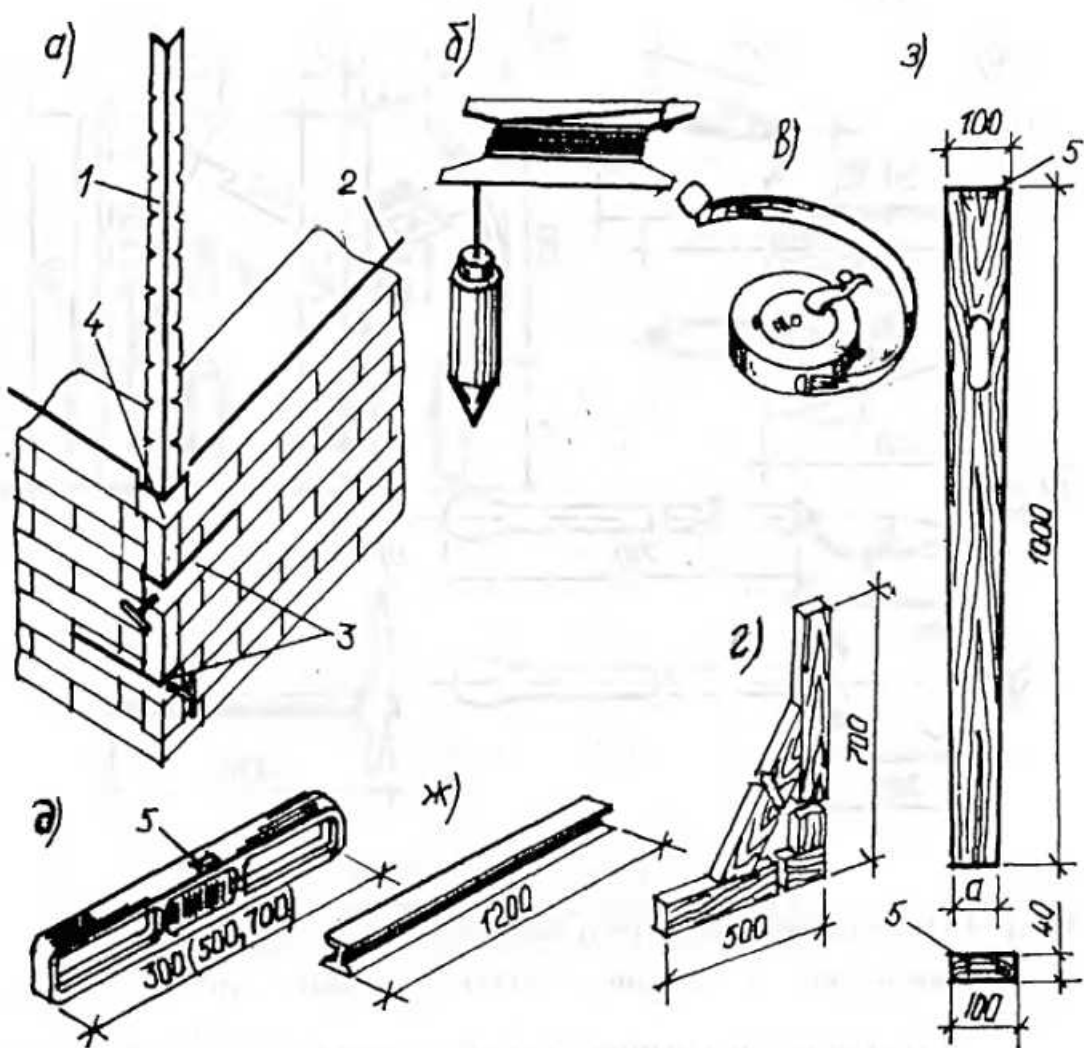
Контрольно-вимірювальний інструмент та пристрої: а - схема встановлення порядковки; б - висок; в-рулетка; г - кутник; д - будівельний рівень; ж - діуралюмінієве правило; з - збавочний рівень; 1 - порядковка; 2 -шнур-причалка; 3 - скоби для кріплення порядковки; 4 - повзунок; 5 - ампула рівня
